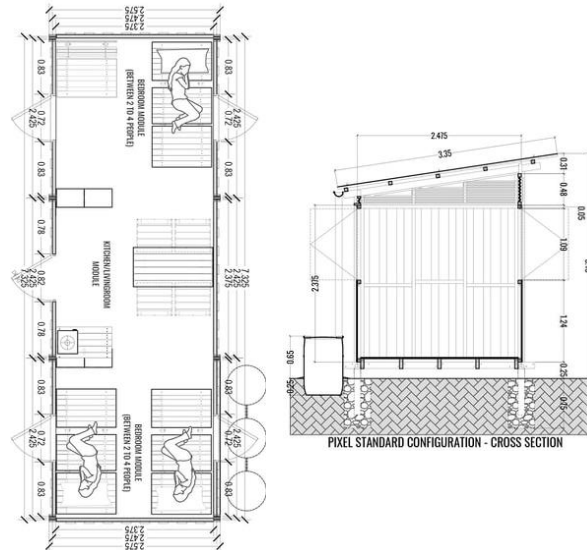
Planta tipo. Fuente: Barillas, L et all. (2017).
